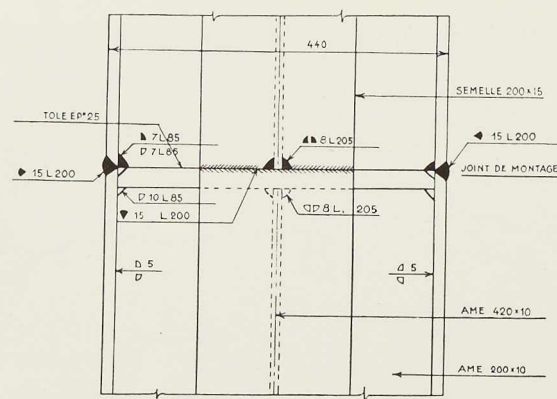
Détail d'un joint soudé dans les montants des ponts de Dudzeele. Les soudures exécutées sur place sont indiquées au moyen d'un secteur noir.
